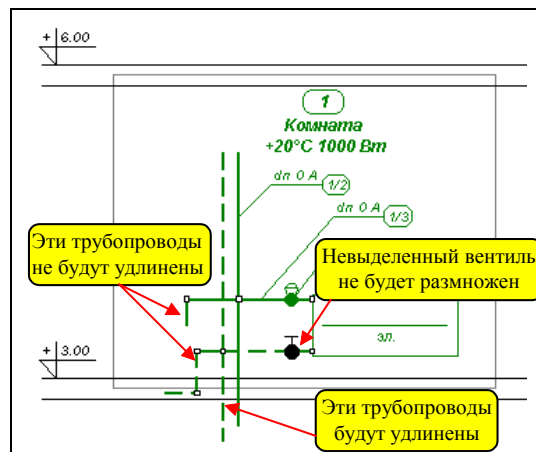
Выделенный фрагмент этажа, подготовленного для размножения на следующем этаже.
